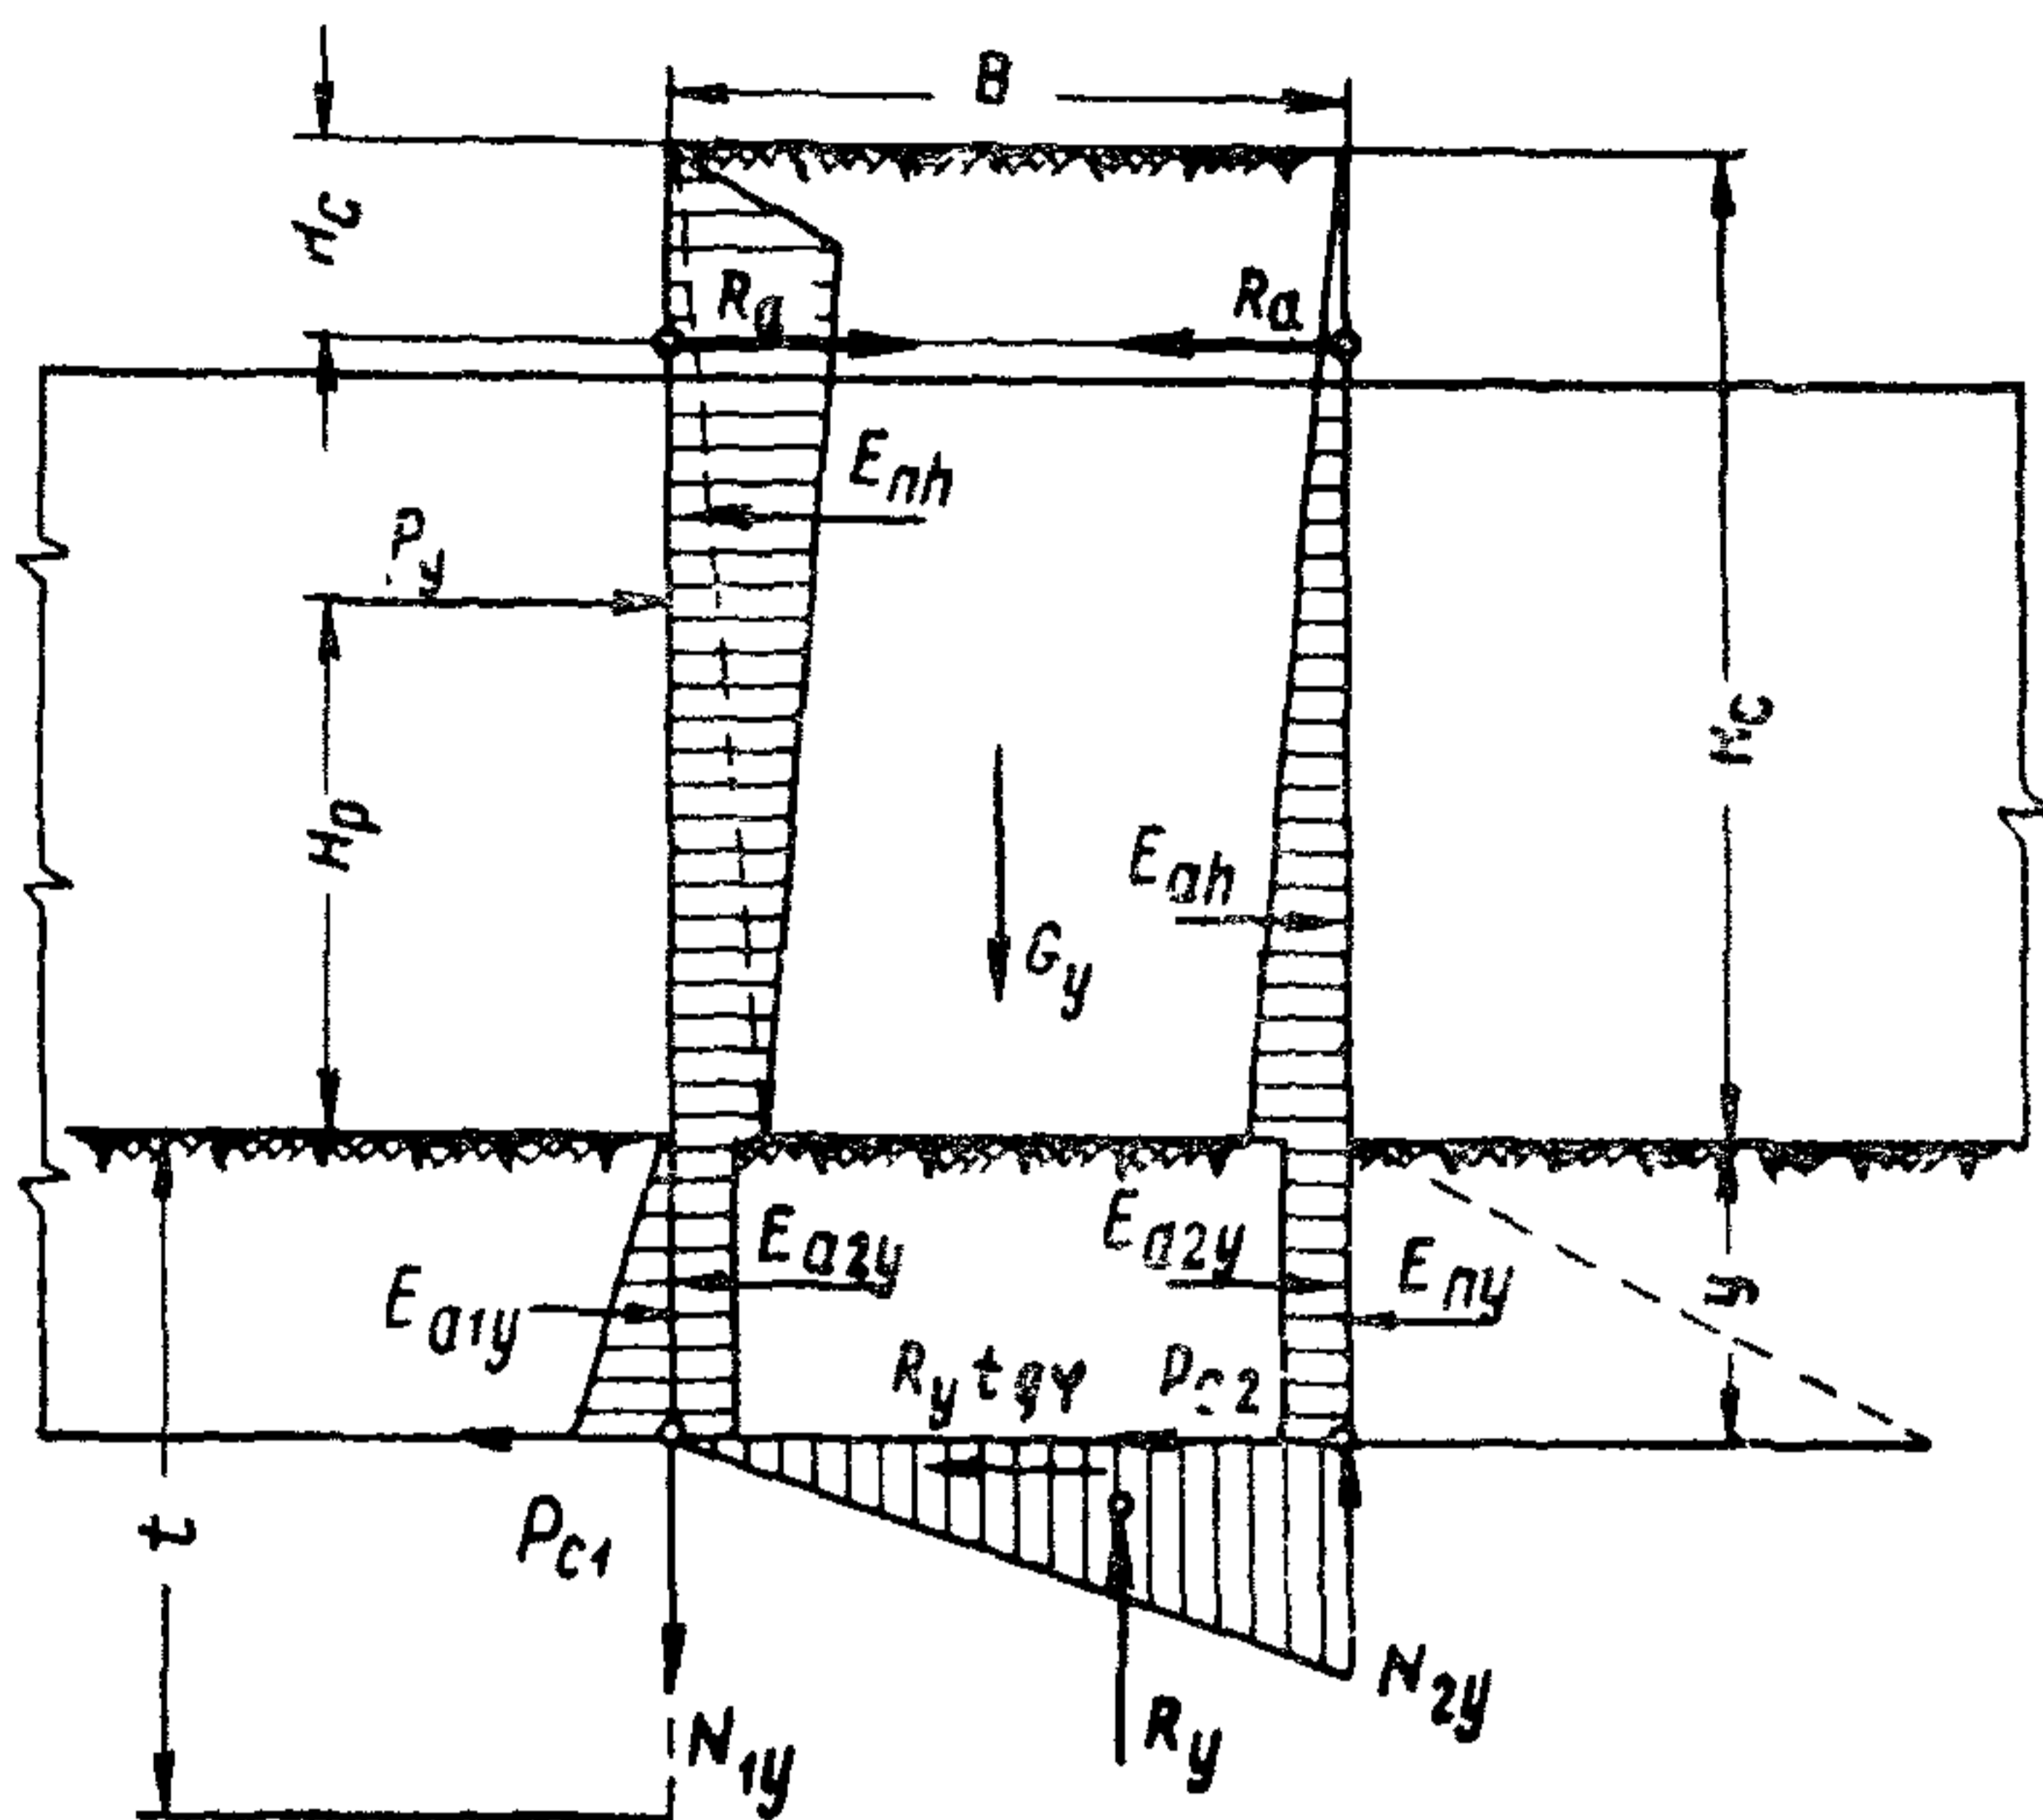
Схема расчета сооружения свайной двухрядной конструкции на сдвиг и поворот
